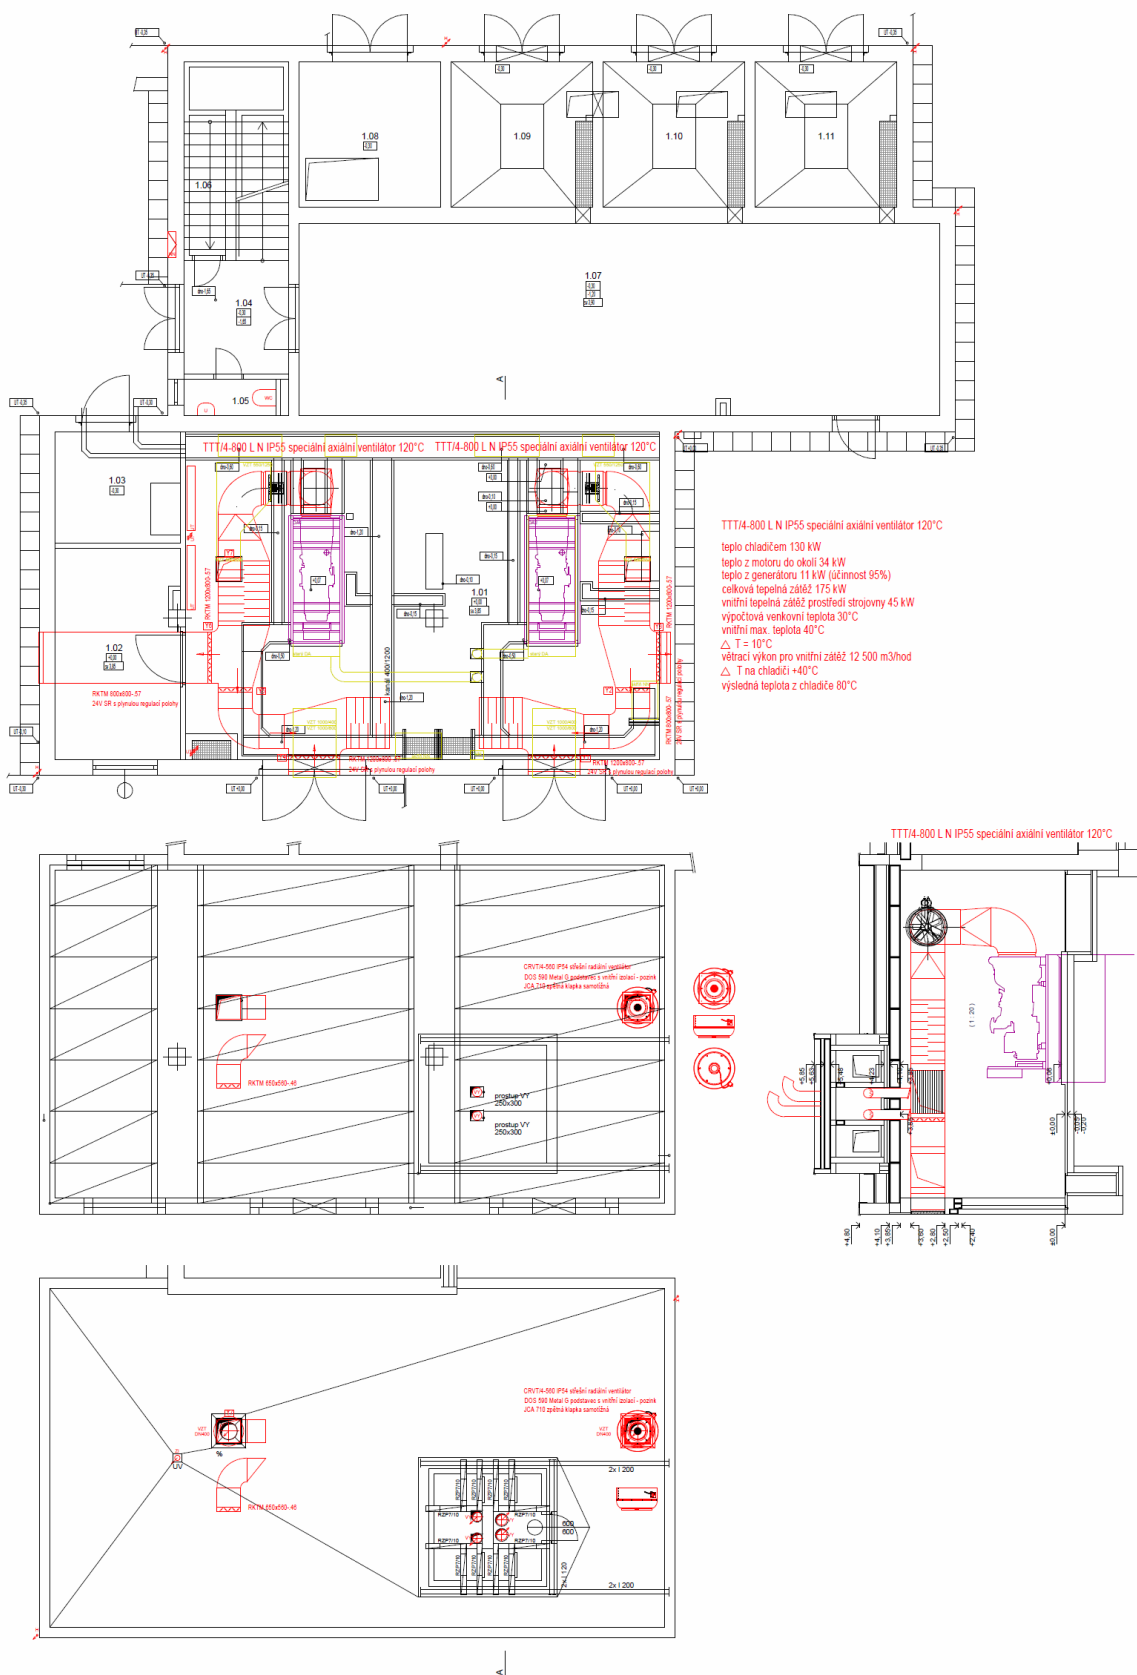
Půdorys 1NP (DA a Mateřská škola)
